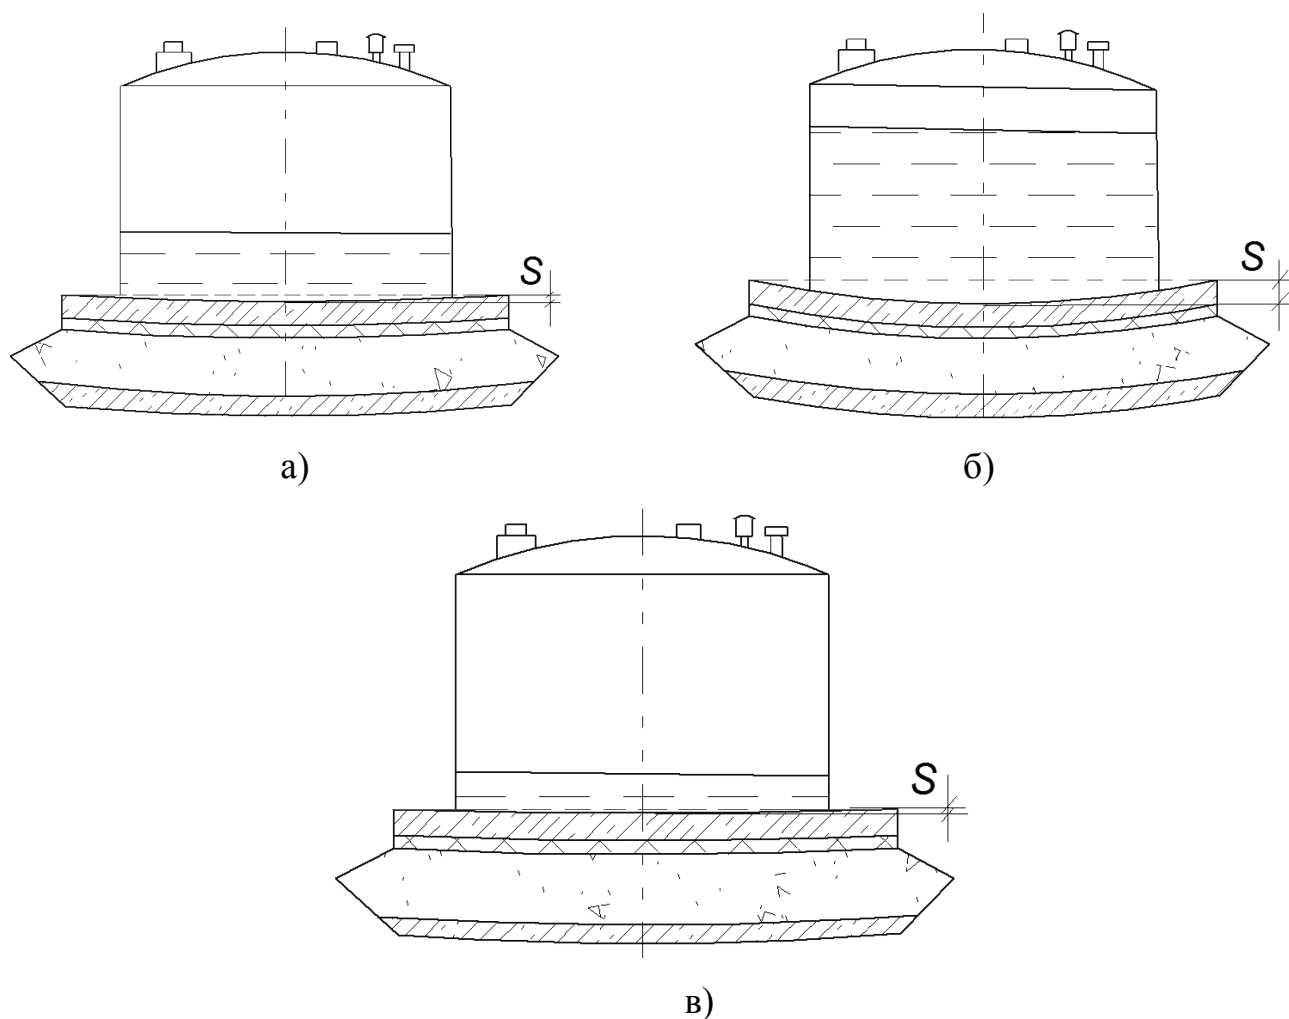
Крен резервуара со смещением фундаментной плиты
